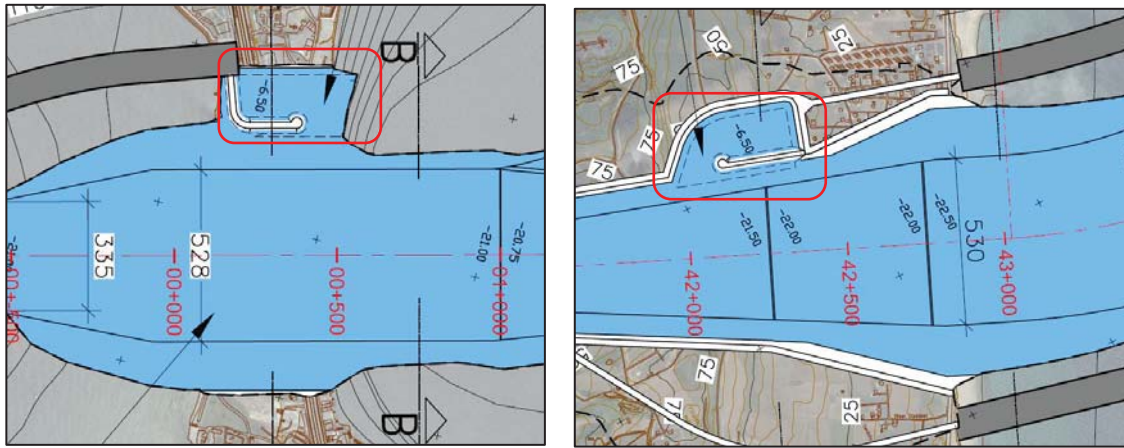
Bir Acil Bağlanma Alanına İlişkin Yerleşim Planı
